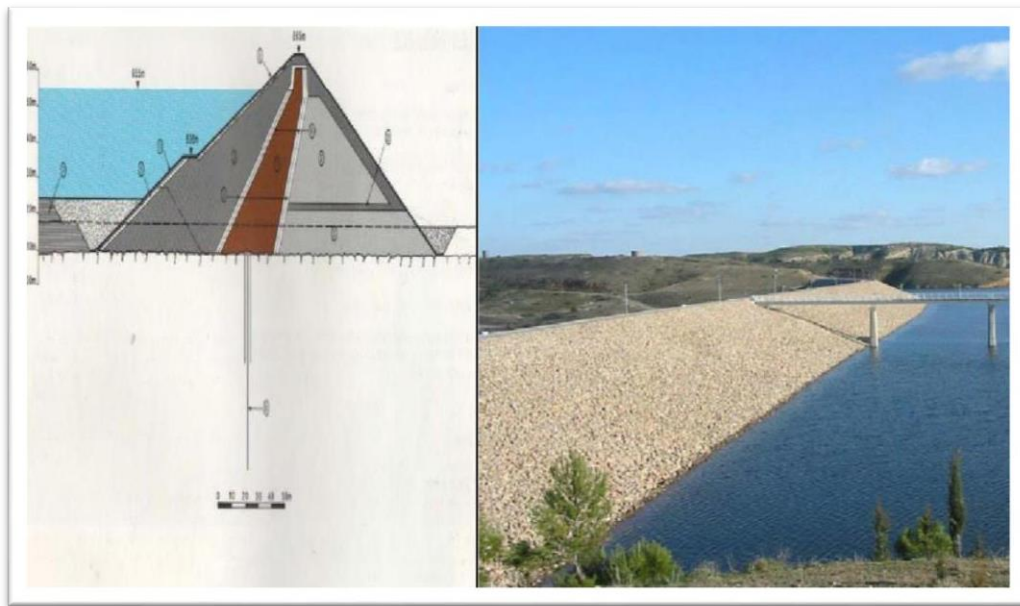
Photo de la digue principale et coupe en travers du barrage d'Ain zada (ANBT 2011).
